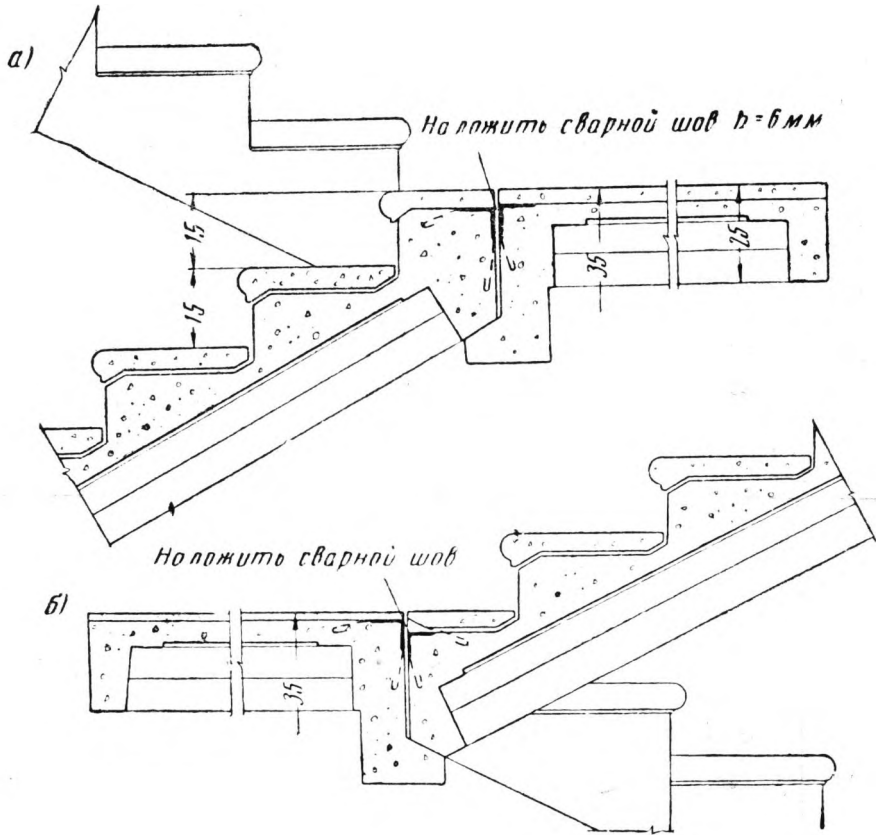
Детали опирания укрупненных сборных железобетонных лестничных маршей
